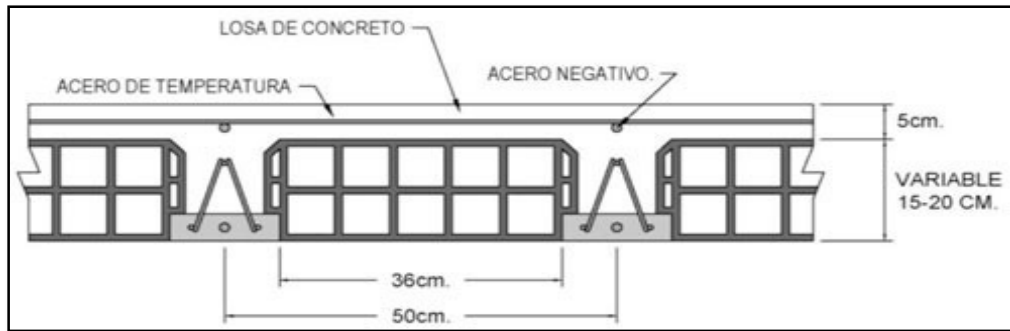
Corte de Aligerado con vigueta tipo tralicho.
